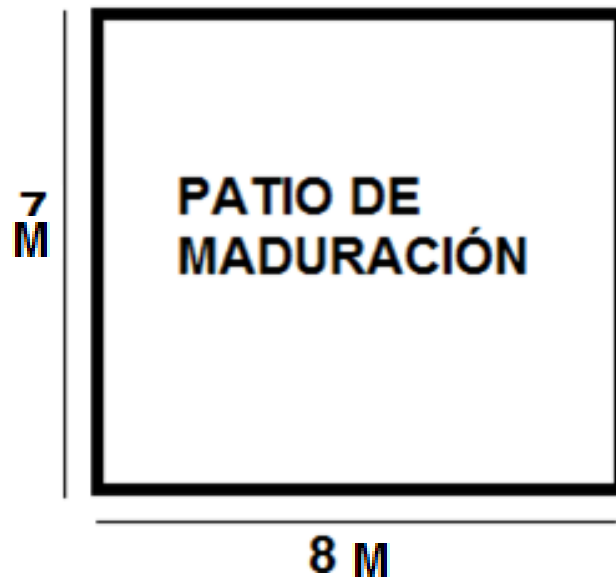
Dimensiones del patio de maduración de la planta de tratamiento
